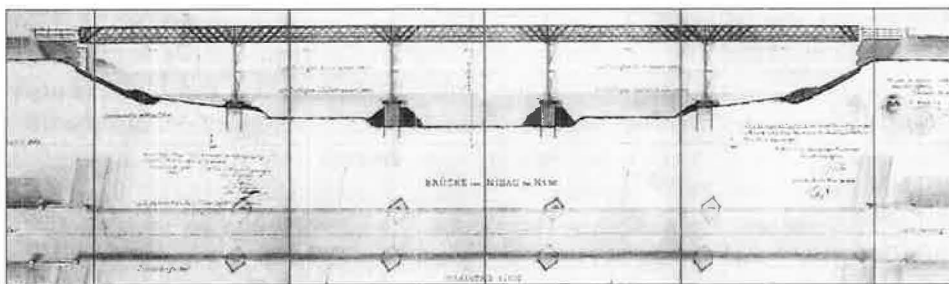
Plan 1:100 (verkleinert), STAB BB 10.4 128, Ansicht der Strassenbrücke von Westen (Eisenfachwerkbrücke) von 1869/70 über den Nidau-Büren-Kanal mit Genehmigungsvermerk des Bundesrates (rechts) und des Regierungsrates (links). Die Tragkonstruktion ist ein kontinuierlicher Träger über 5 Öffnungen von je 18 m Spannweite, Länge 90 m, Fahrbahnbreite 5 m. Belag aus Zoreisen und Kiesmacadam. Vier Brückenpfeiler aus Eisen, gelagert auf Pfahjochen mit Betonsockel unter Niederwasser bis zur Flusssohle. Projektverfasser Gustav Bridel, Oberingenieur 1. JGK. Herstellung der Eisenteile, total 108 Tonnen Eisen, durch Werkstätte der 1. JGK in Nidau.
